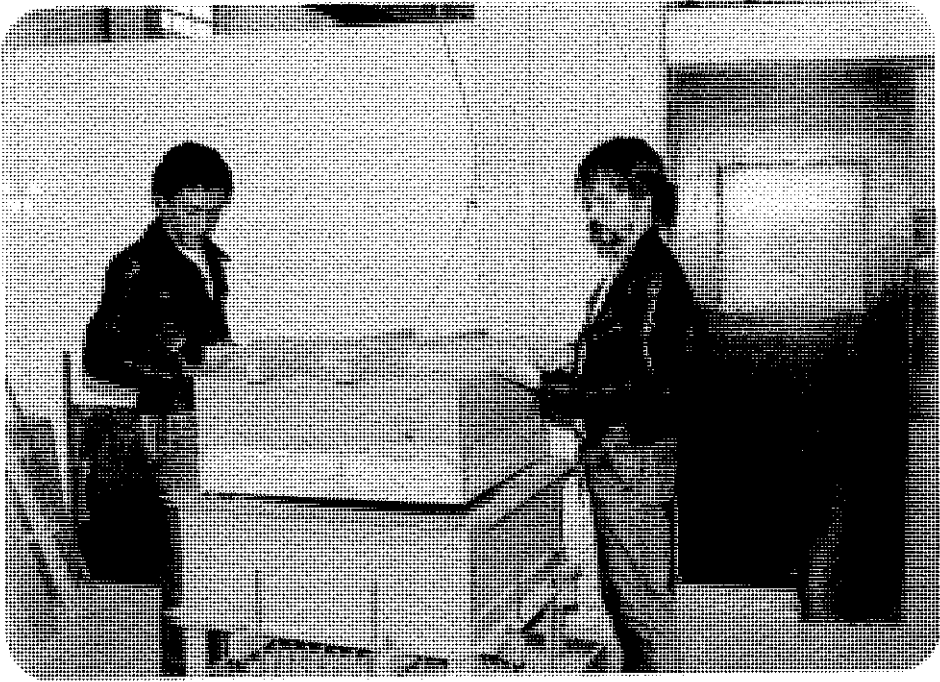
Detalhe da colocação da estrutura de aplicação do carregamento.
